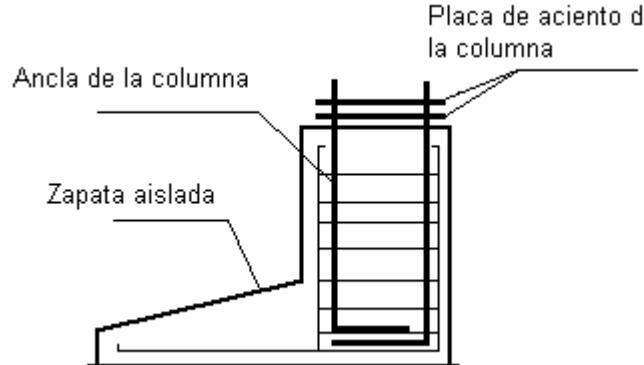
Propuesta del anclaje de las columnas en las zapatas.
